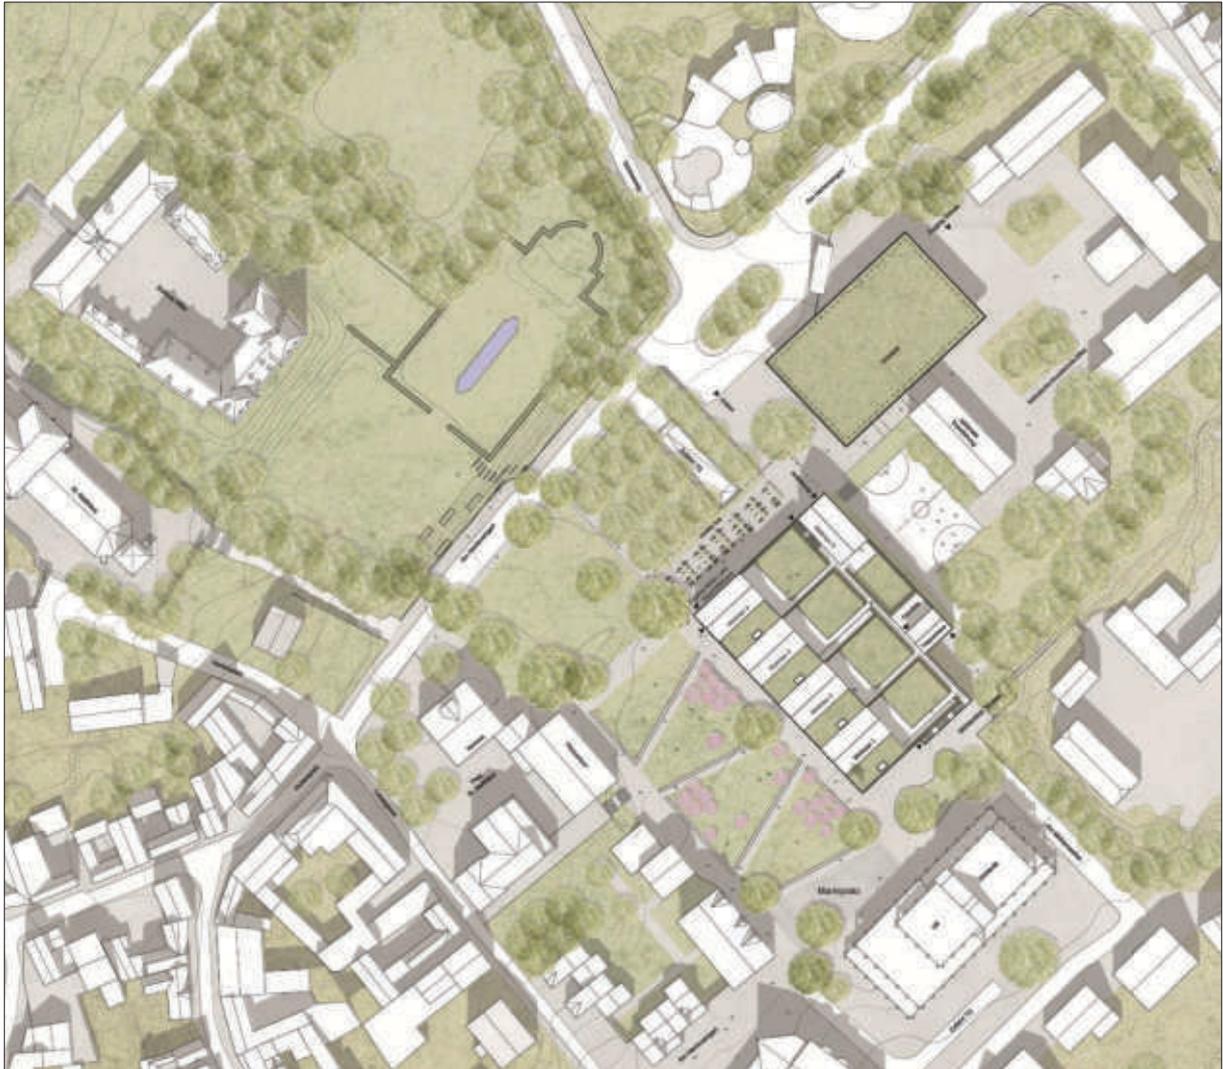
Lageplan: Städtebauliches Konzept Büro Königs Architekten, Köln
